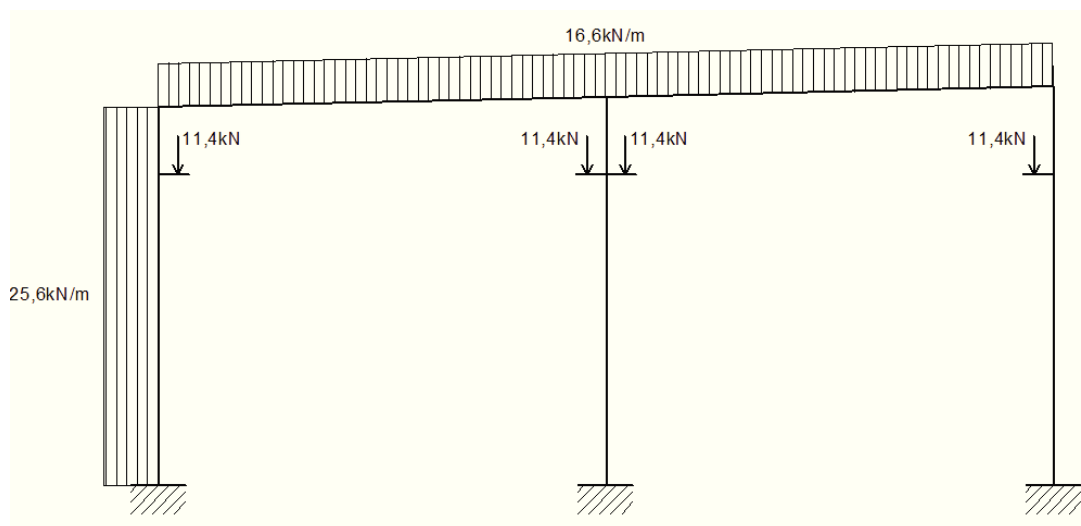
geometrie vybraného rámu pro posouzení
